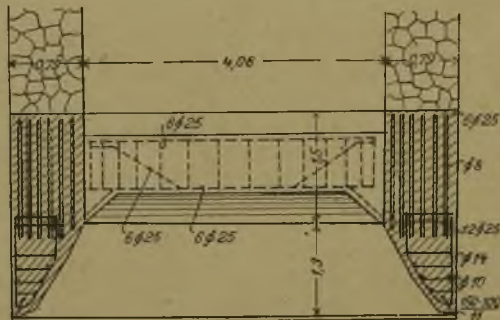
Ausbildung des Eisenbeton-Brunnenkranzes des Hauptschachtes in Abbildung 1.
